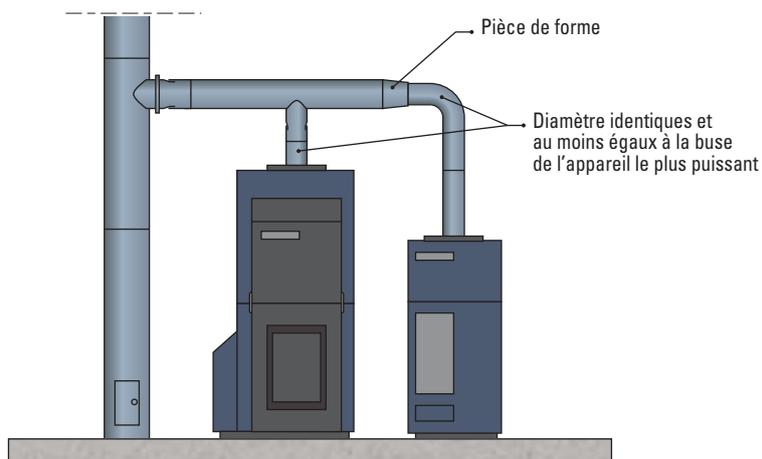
Exemple de raccordement de plusieurs appareils sur un même conduit de raccordement
